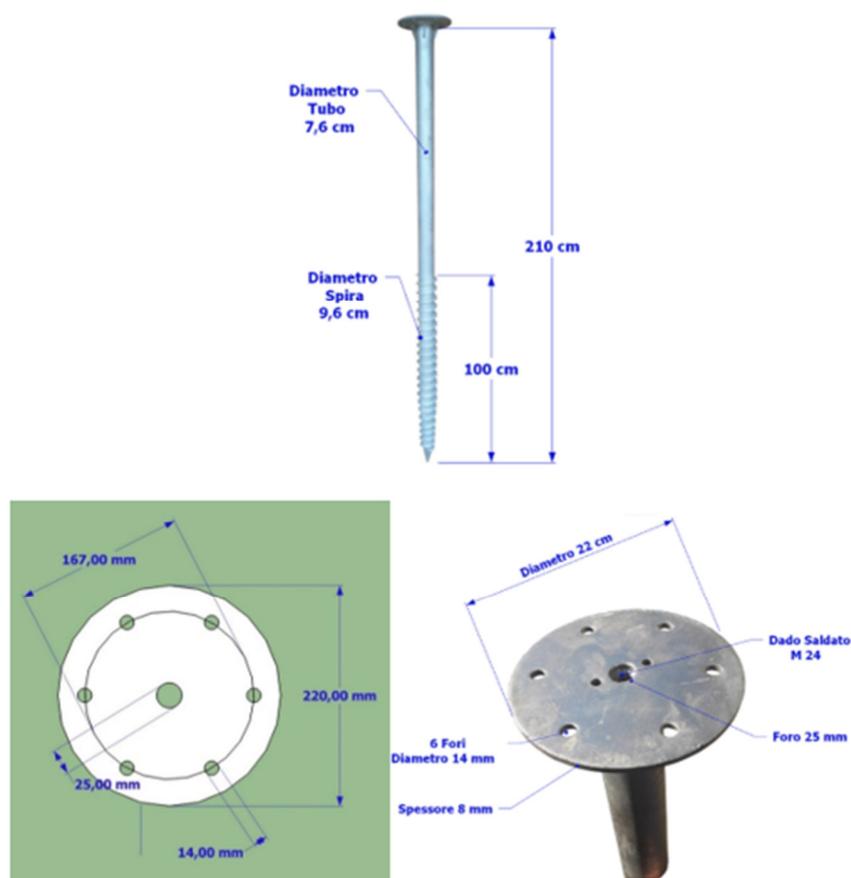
Tipologia di fondazione a vite per strutture Tracker.
